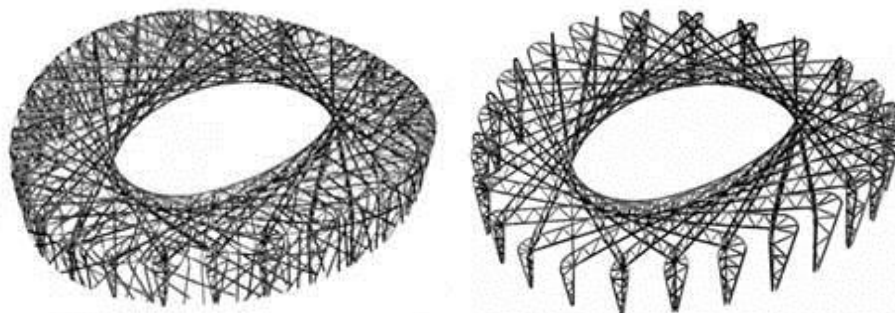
Двадцать четыре фермы опоры здания переплетены «стяжками»
